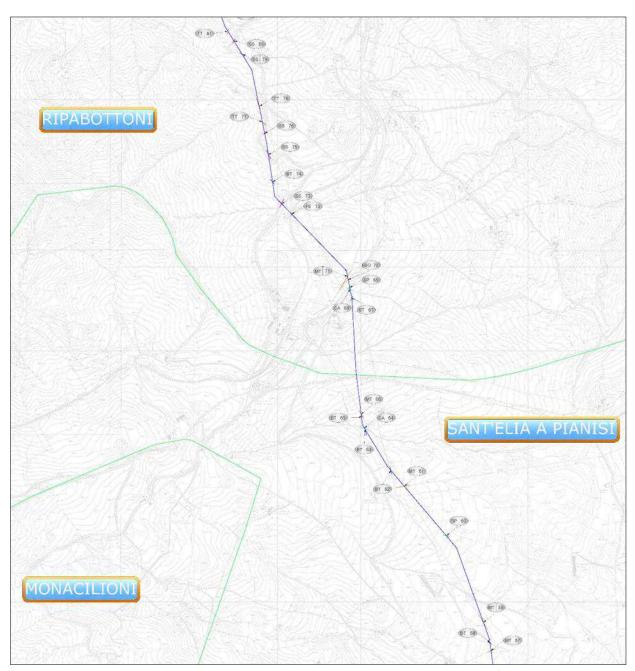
Stralcio planimetria tracciato elettrodotto su CTR (4/5)
